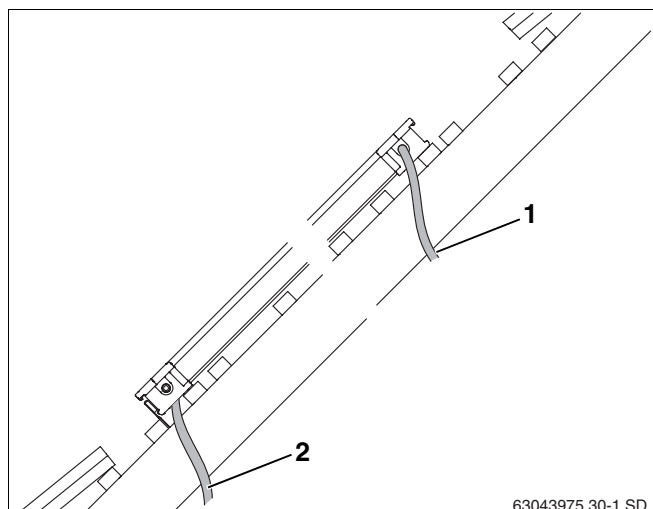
Sistemazione delle tubazioni di allacciamento sotto il tetto
